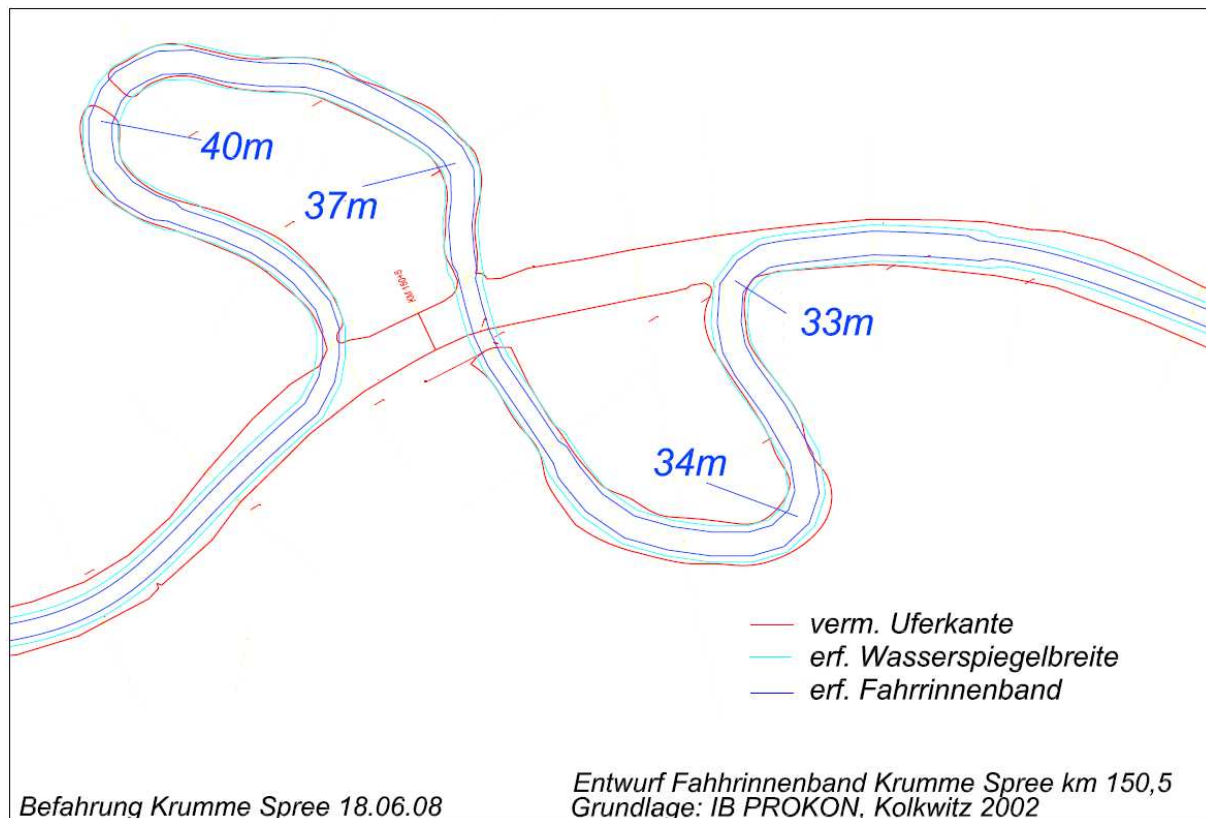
Grundrissdarstellung der notwendigen Gewässergeometrien entsprechend Einhaltung der Schifffahrtserfordernisse
